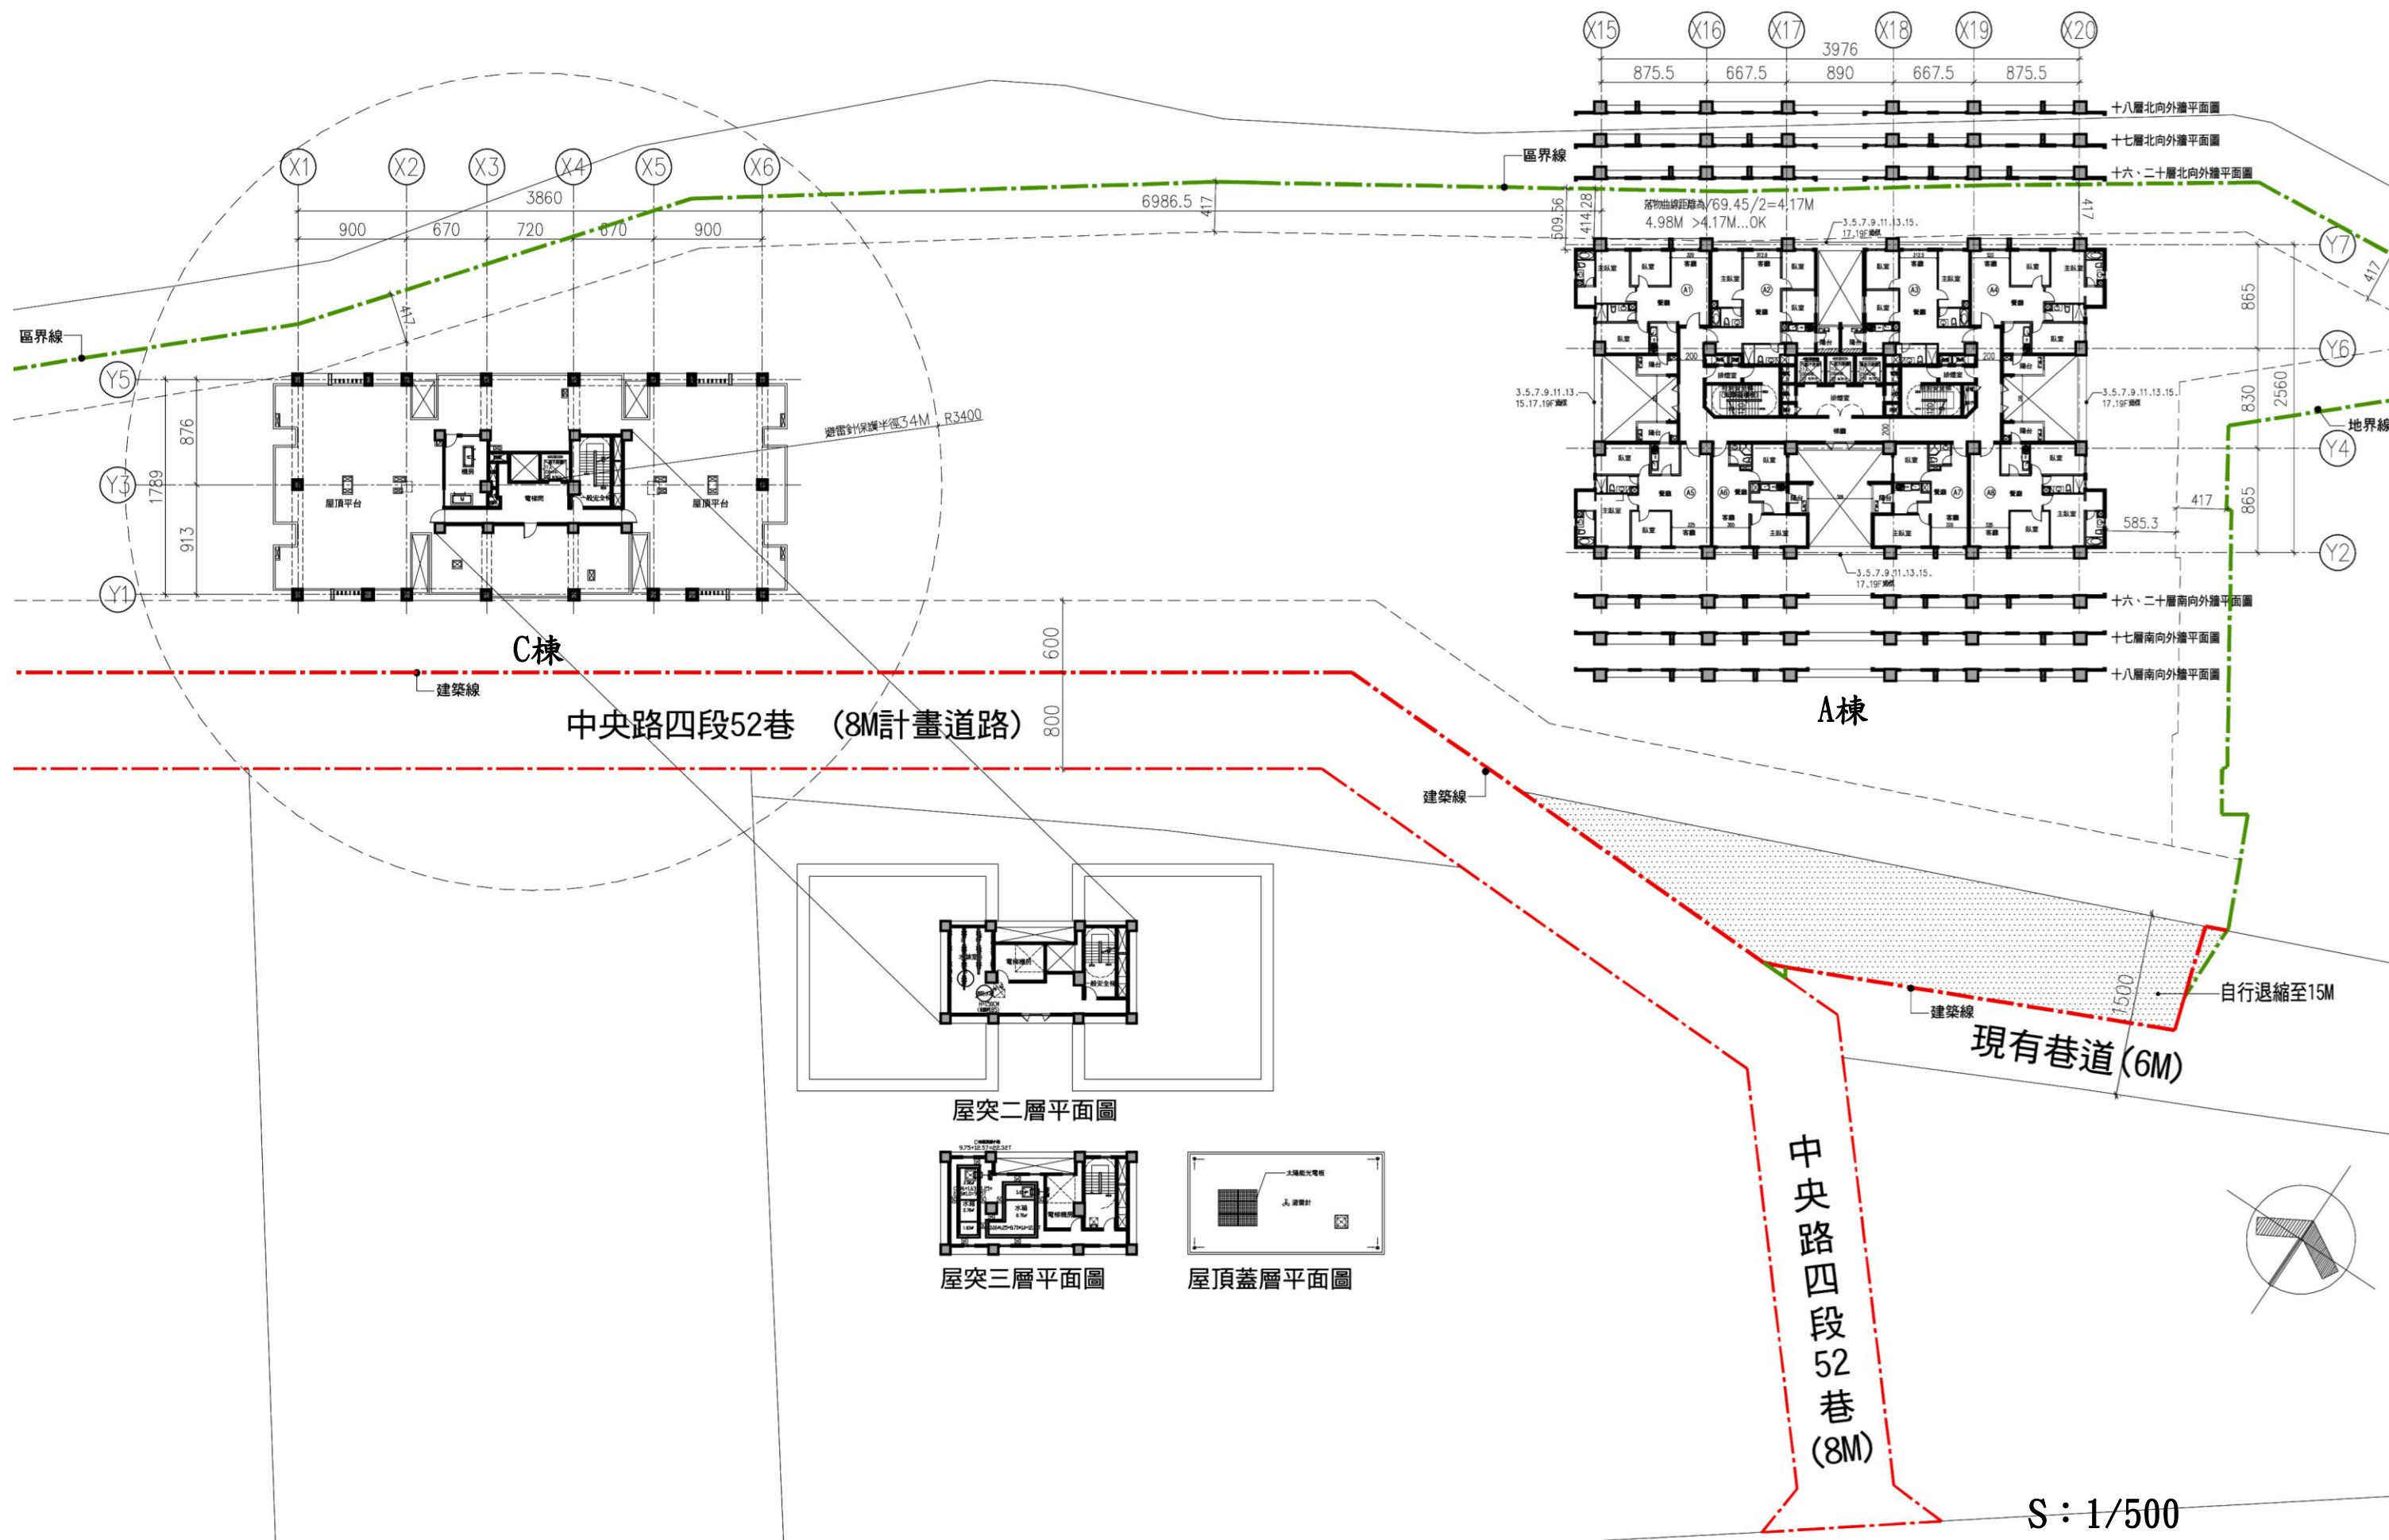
A 棟十五至二十層、C 棟屋突層平面圖
